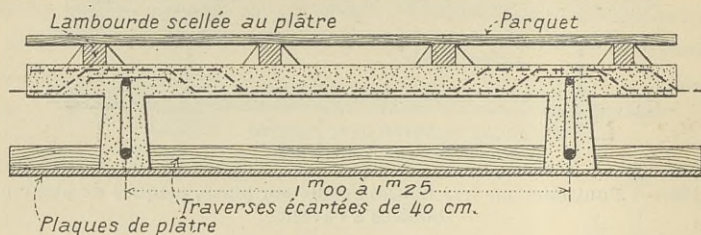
Nervures à section en queue d'aronde et dalle en béton armé.
